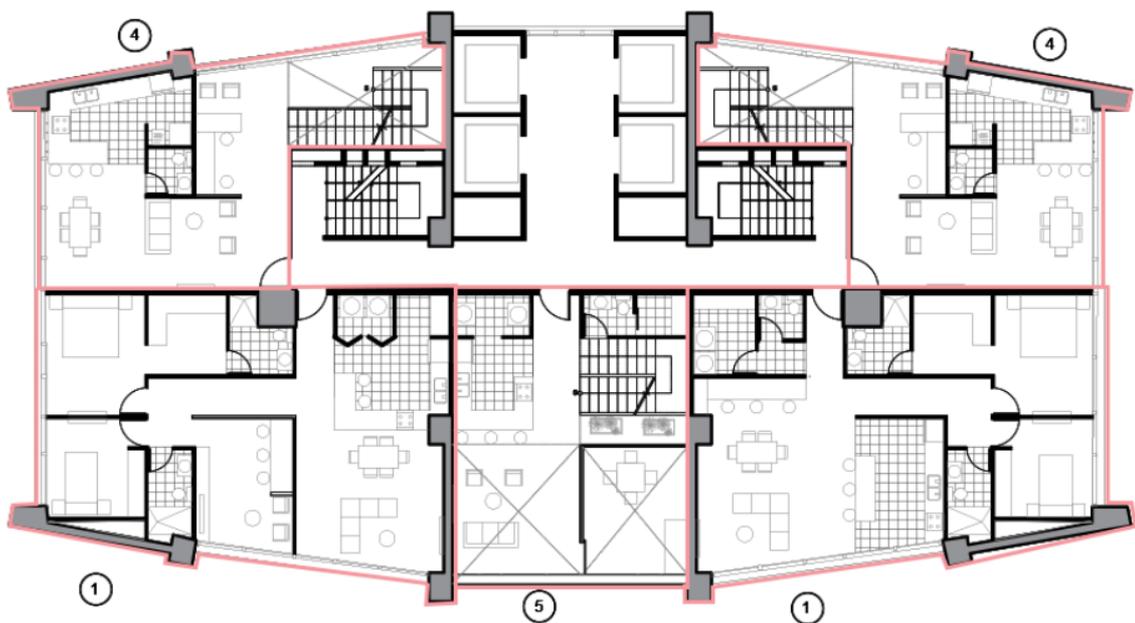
PLANTA TIPO 1. Elaboración Propia.
